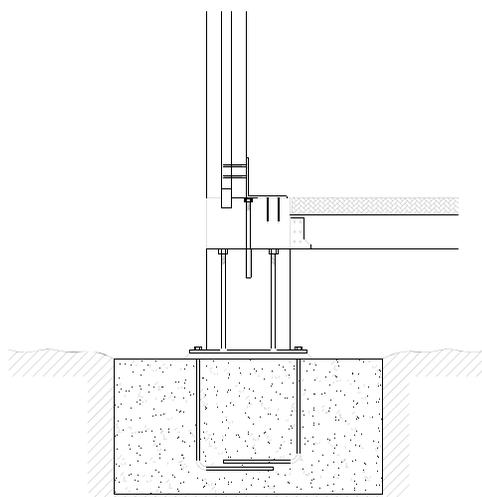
Detalle de la unión a viga riostra, enano y cimentación.
